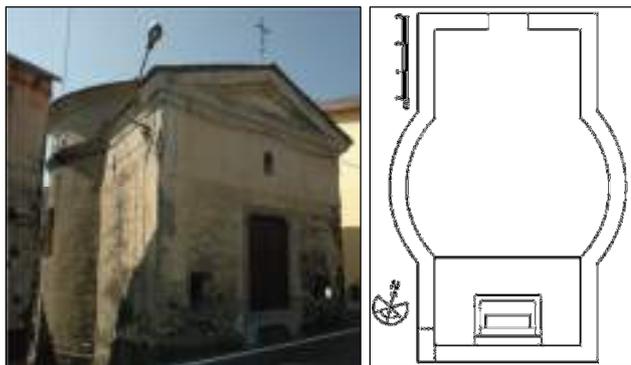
/3.16 Facciata e pianta dell'oratorio di San Sebastiano
